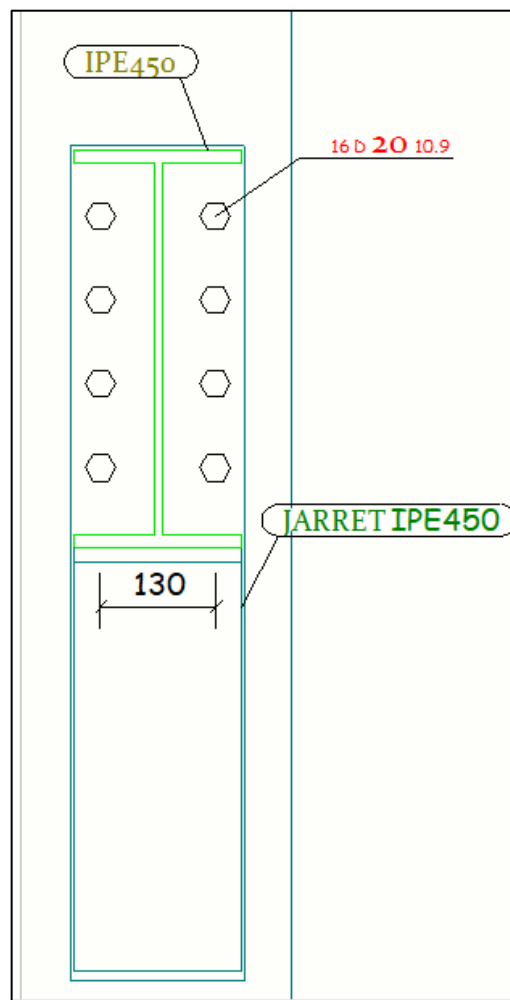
Disposition constructive des boulons (assemblage poteau-poutre principale) dessiné sur le logiciel TEKLA
